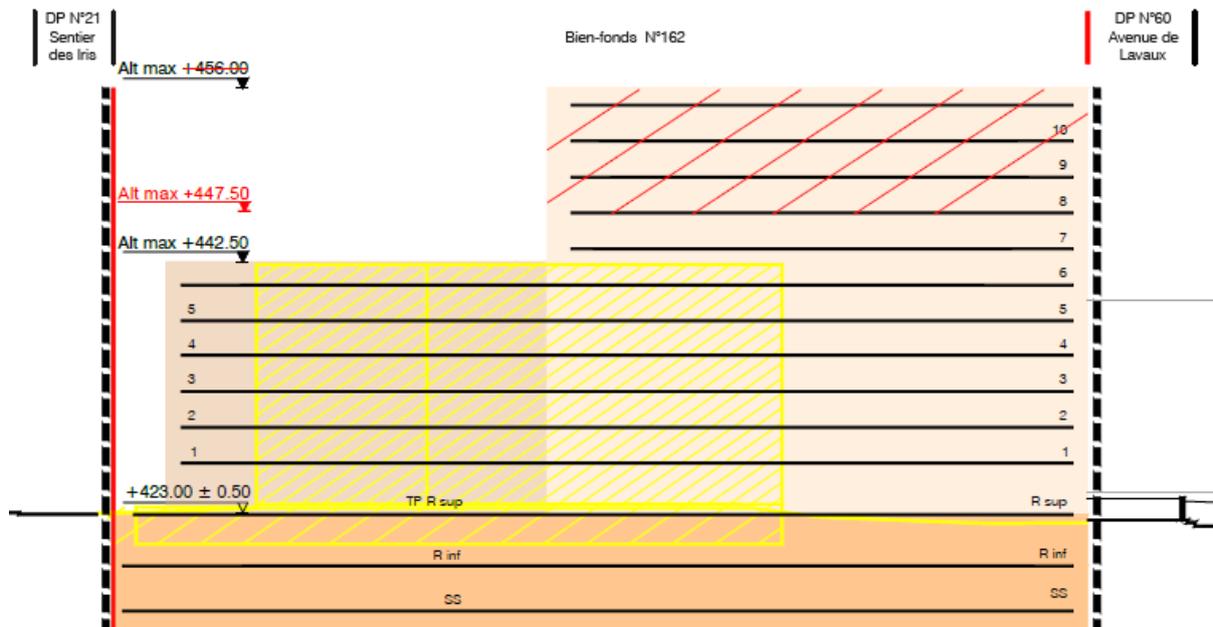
coupe du plan de détail du PA "Claire-Fontaine II" amendé - @Ville de Pully
